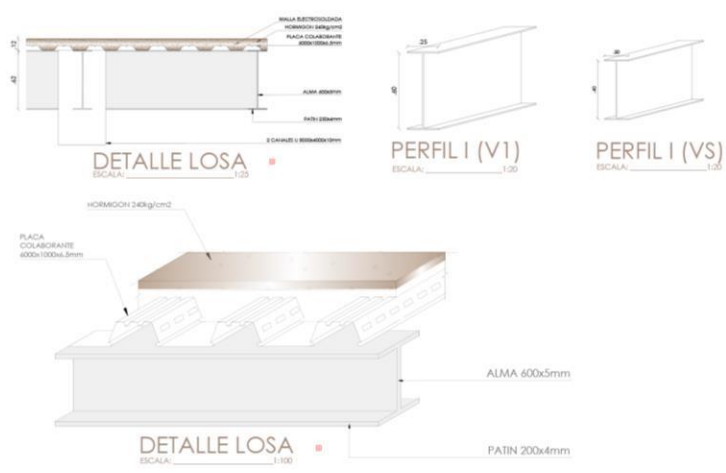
Detalle armado de losa y perfiles I escala gráfica 1:100
